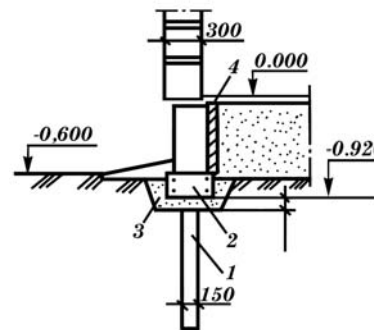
Общий вид конструктивной схемы основания дома с набивными микросваями: 1 – микросвая; 2 – сборная плитная перемычка с выпусками продольной арматуры; 3 – подушка из гравийно-песчаной смеси; 4 – утеплитель из пенополистирола
